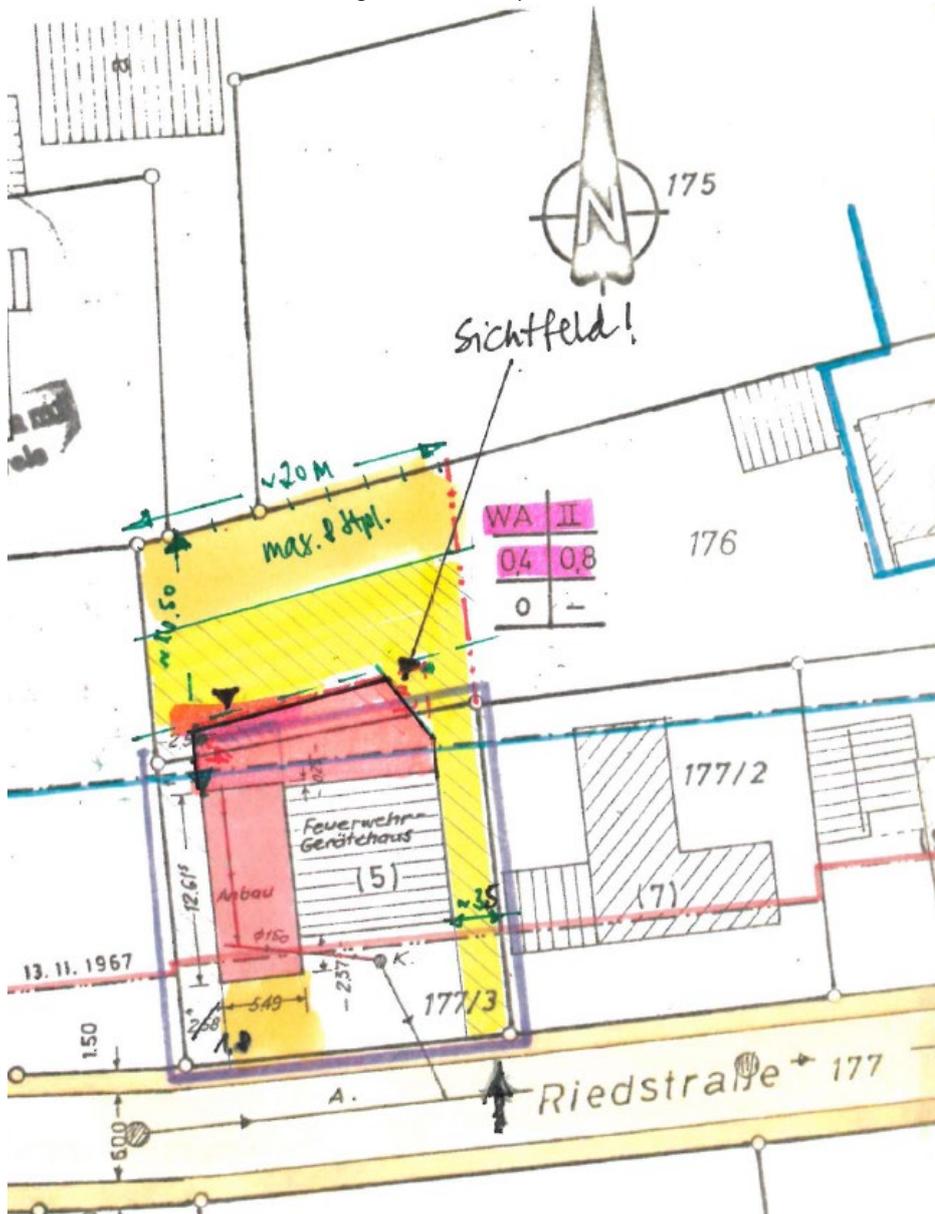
Lageplanskizze mit Zubau und Parkplatz, ohne Maßstab
